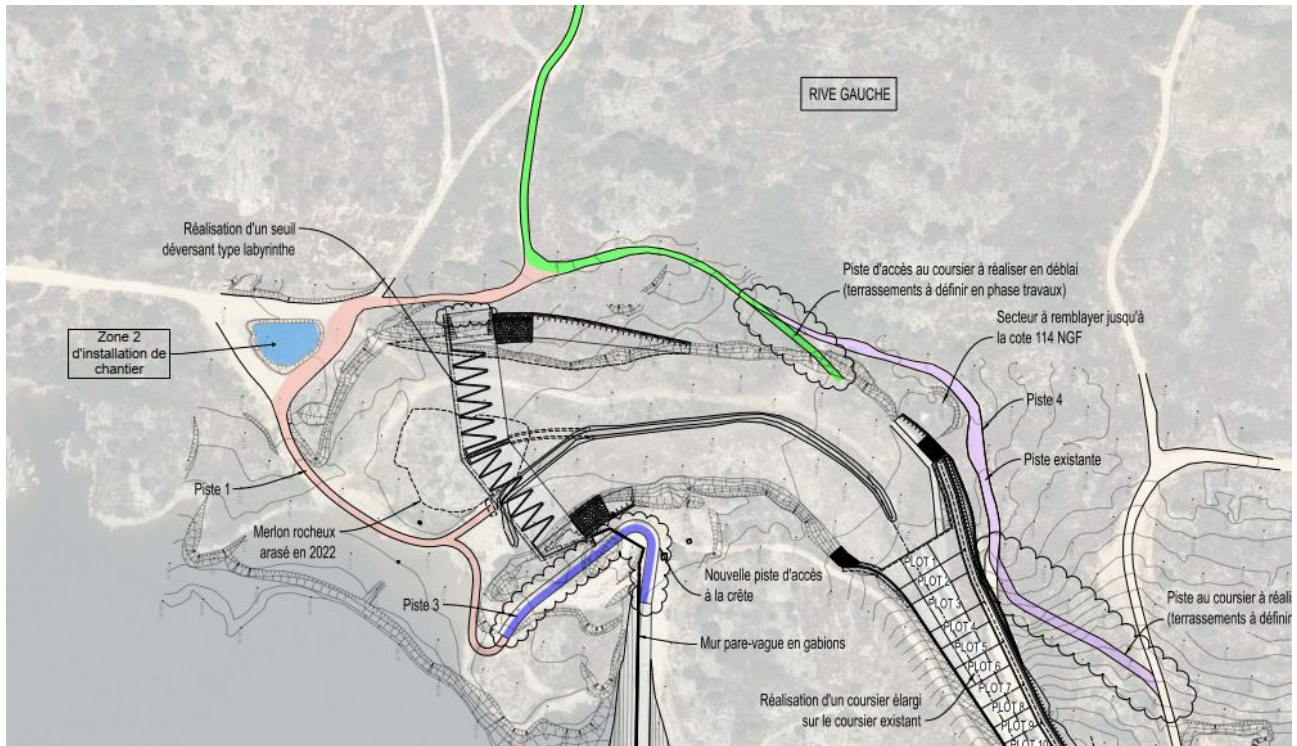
Pistes d'accès au chantier depuis les installations de chantier
